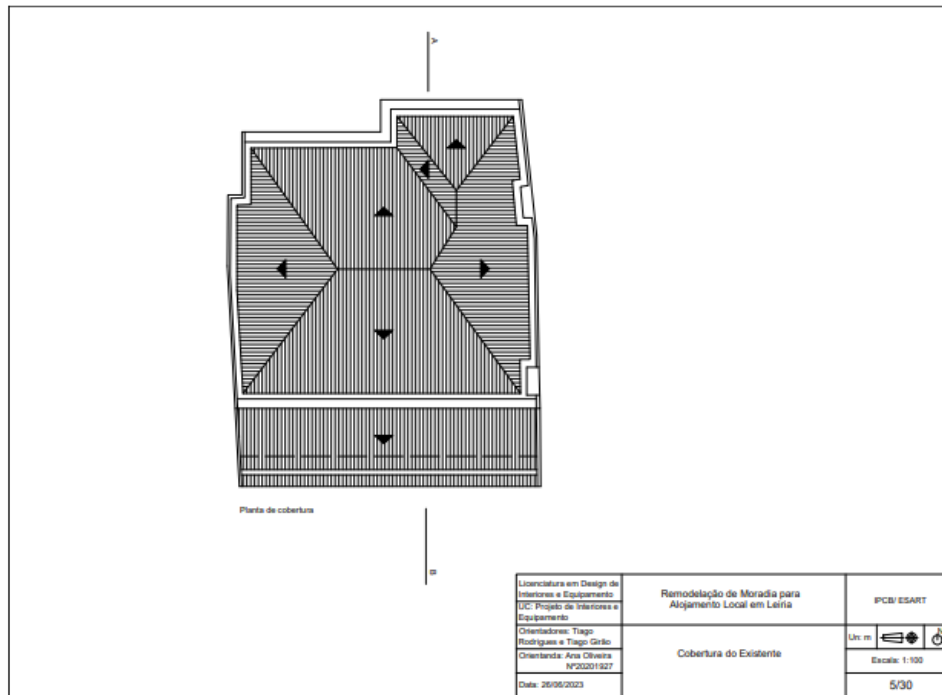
Planta de Cobertura, fonte Câmara Municipal de Leiria
